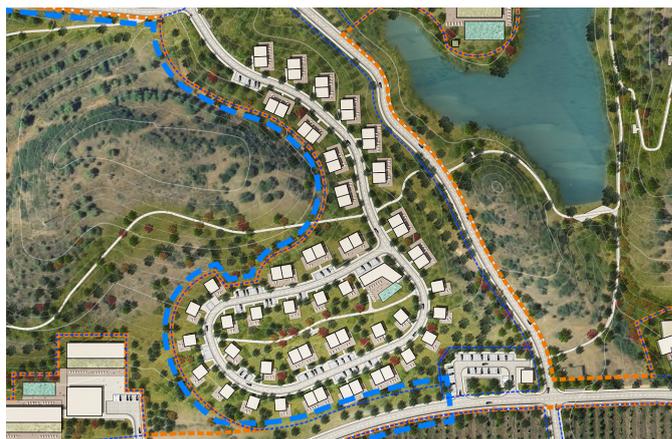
Extrato da Planta Ilustrativa, Aldeamento Turístico da UP 14
